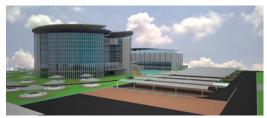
Siteplan Information Technology Center (Sumber: Pengembangan Desain)
